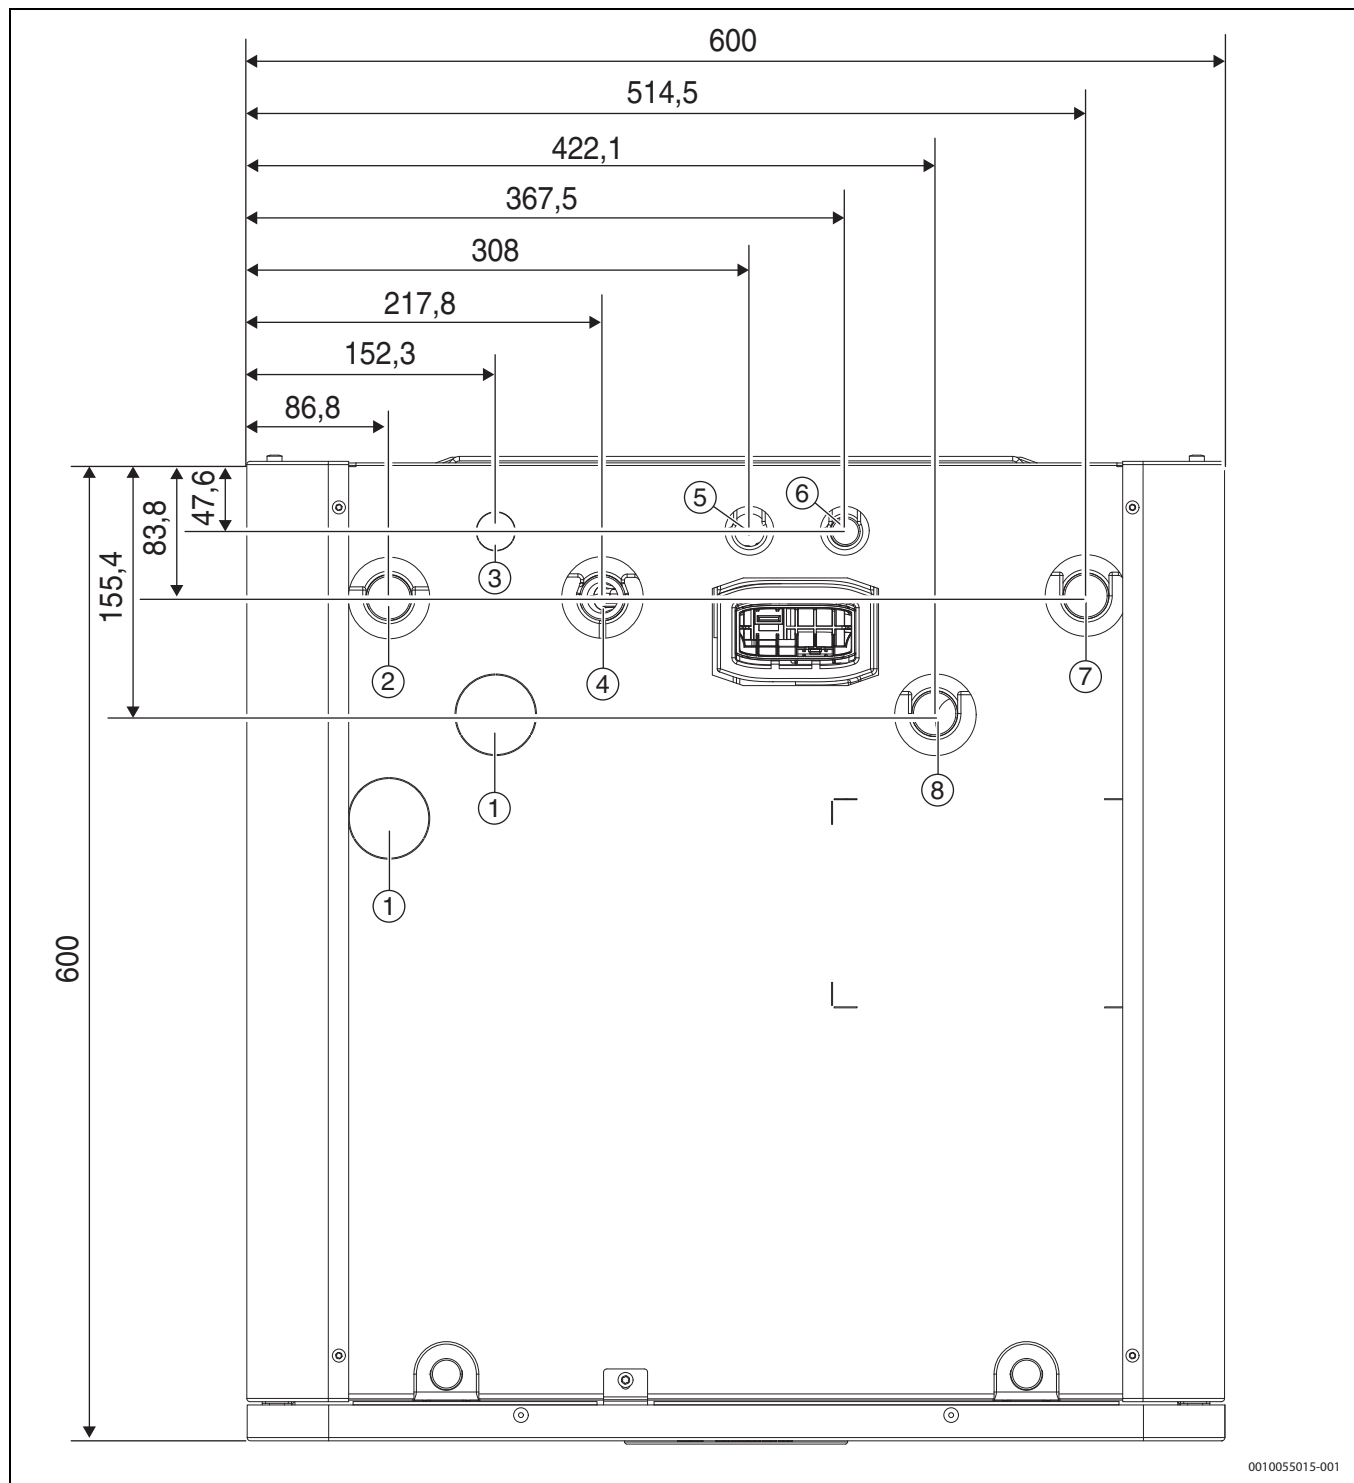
Abmessungen, Anschlüsse, Draufsicht (Maße in mm)
